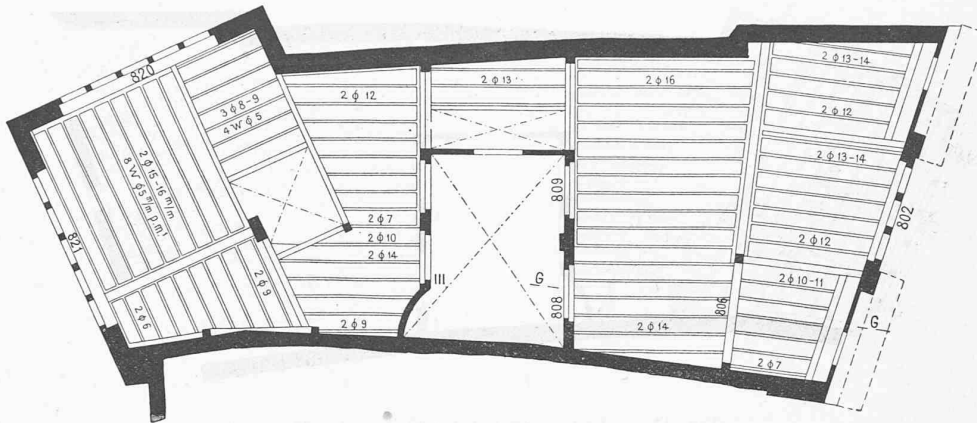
Plancher sur 2° étage. — 1 : 200.
